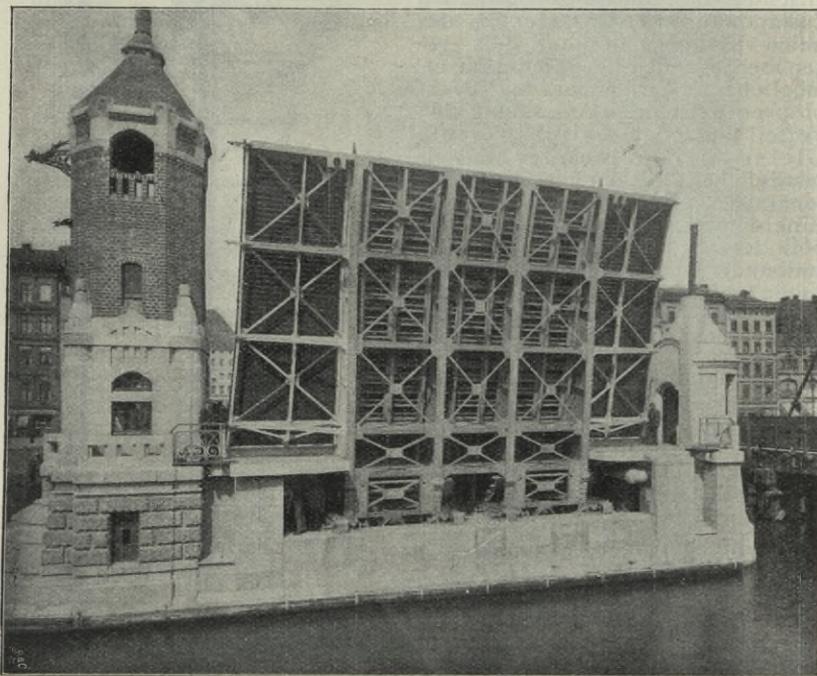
Hansabrücke in Stettin mit hochgeschlagener Klappe. Aus D. B. Z. 1906 S. 155.
